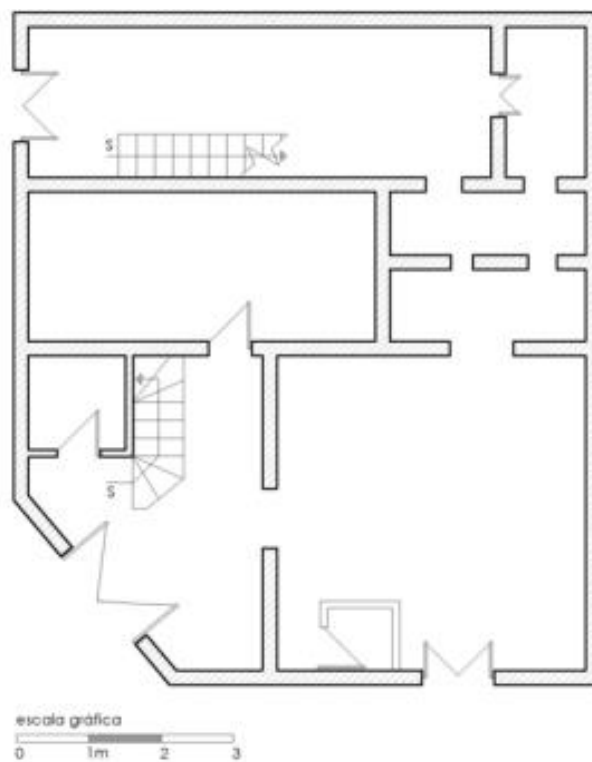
Planta de la vivienda patrimonial con valor arquitectónico
